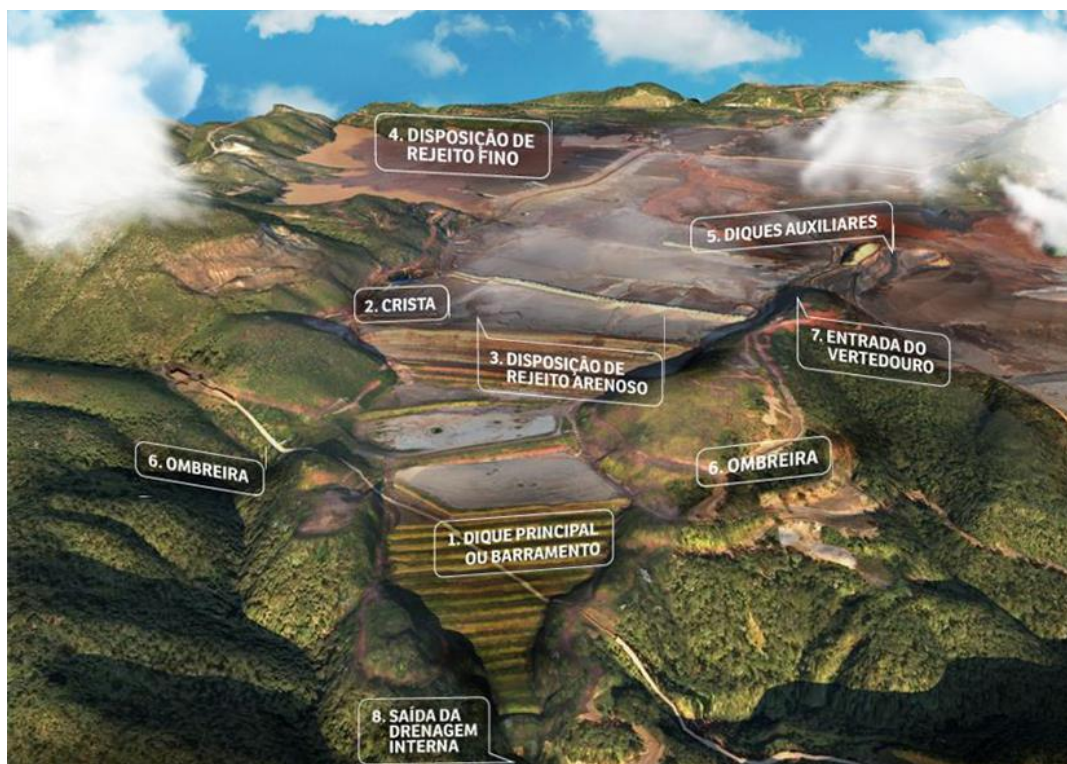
Inventário de estruturas – Modelo Barragem de Fundão.
